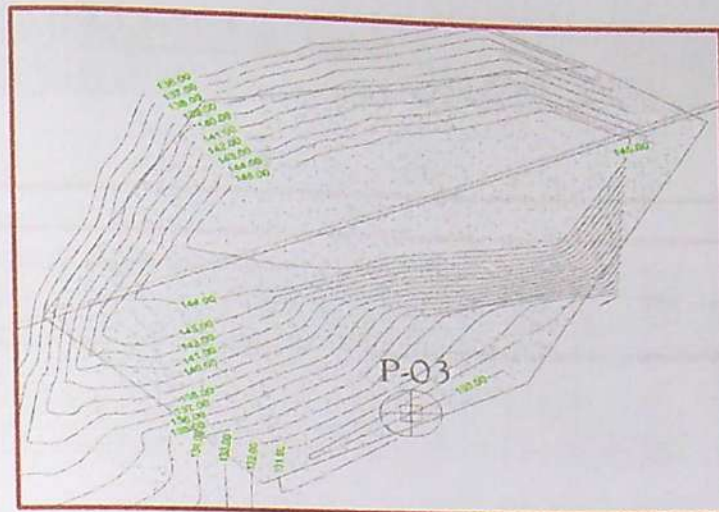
Centro Arenal, plantas topográficas levantadas con GPS.
